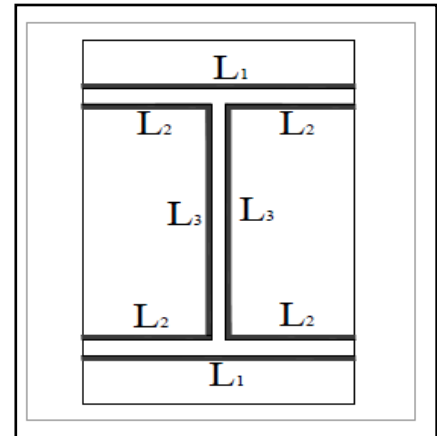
Assemblage soudé poutre-platine.
